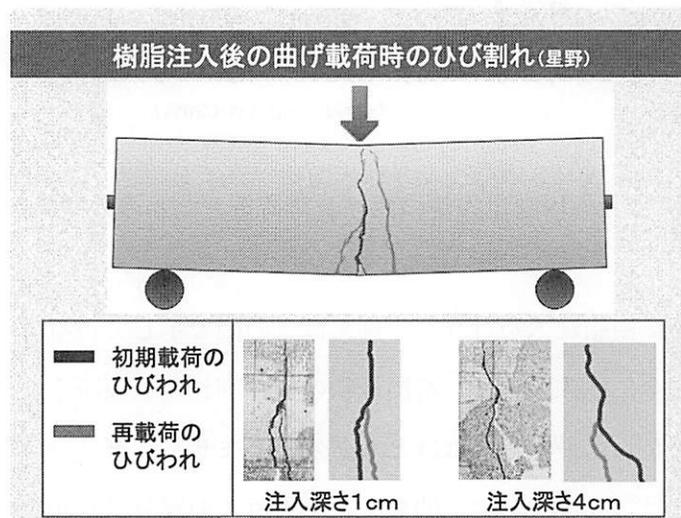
樹脂注入後の曲げ載荷時のひび割れ
